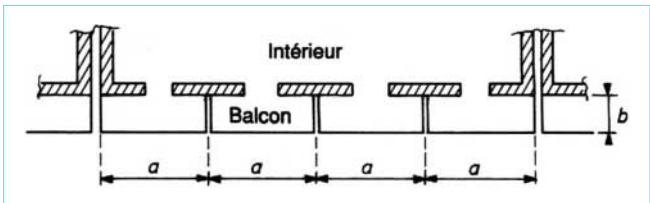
Coupe horizontale de la façade d'un immeuble avec balcons
